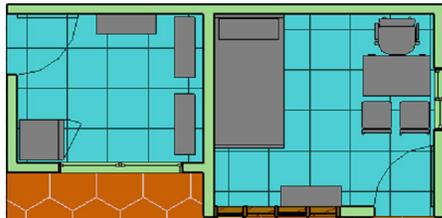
Planta arquitectónica de la enfermería y miscelánea.
